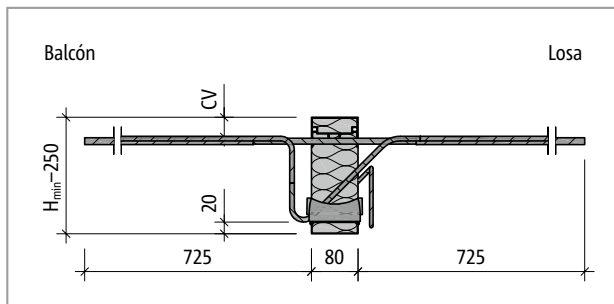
Schöck Isokorb® T tipo K-M7 hasta M11 en R0: Sección del producto
